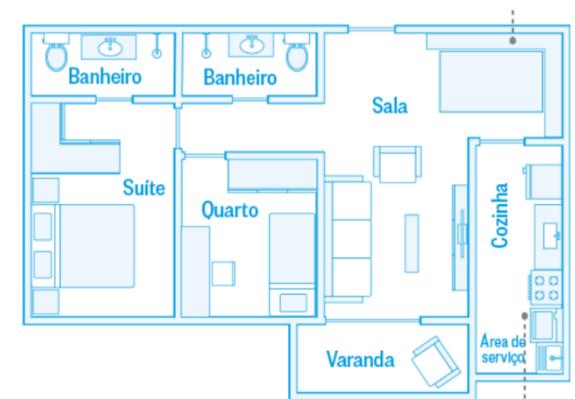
Planta baixa anos 2010. (Fonte: Blog da arquitetura)
